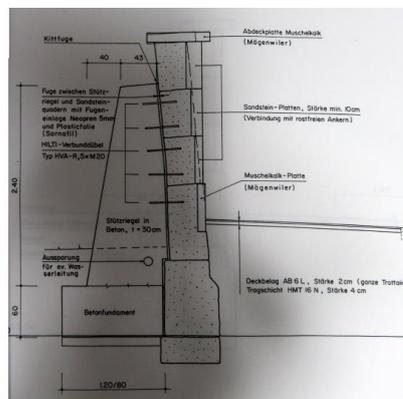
Sanierung Mauer Laubeggstrasse (Stadtgrün Bern)
